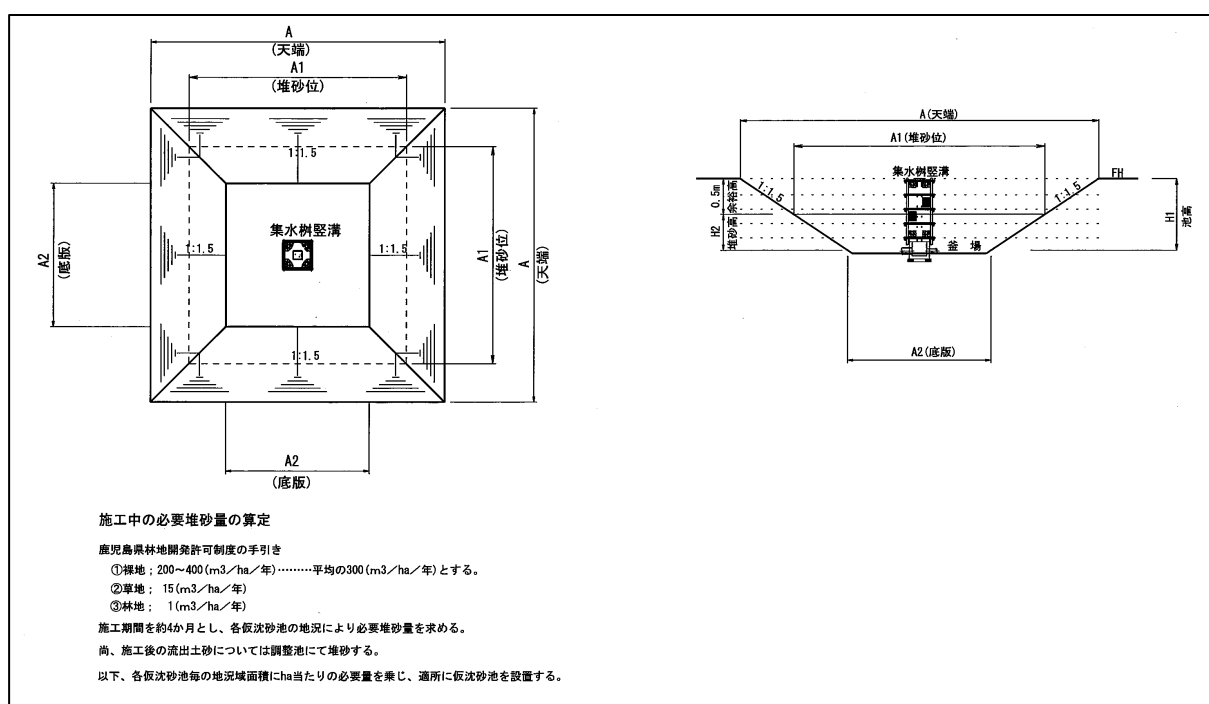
仮設沈砂池の構造（左：平面図、右：断面図）
